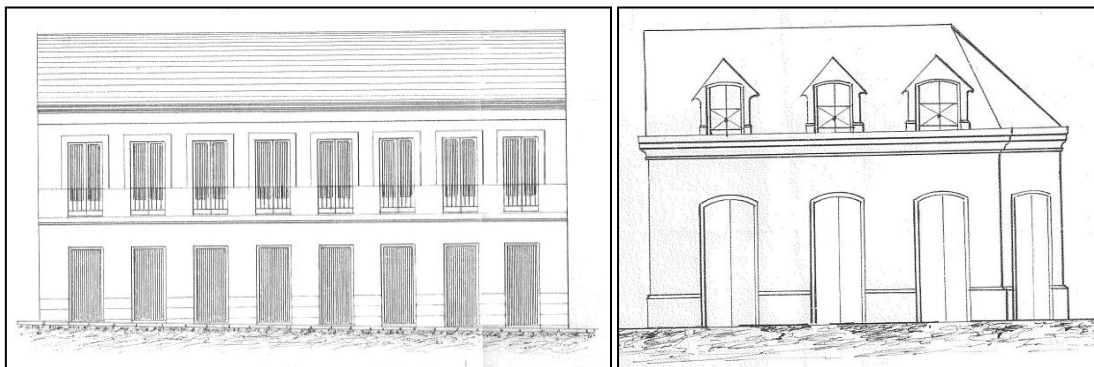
A la izquierda, alzado de la casa que Joaquín Hoyos de la Fuente edificó en el solar nº 10 de la manzana 321 del Ensanche. Licencia solicitada en 1875. AVM, Secretaría, signatura 5-115-15. A la derecha, fachada de la casa de planta baja realizada por encargo de Luis Calvo Pérez en el solar nº 35 de la carretera de Aragón. Licencia solicitada en 1877. AVM, Secretaría, signatura 5-194-62.
